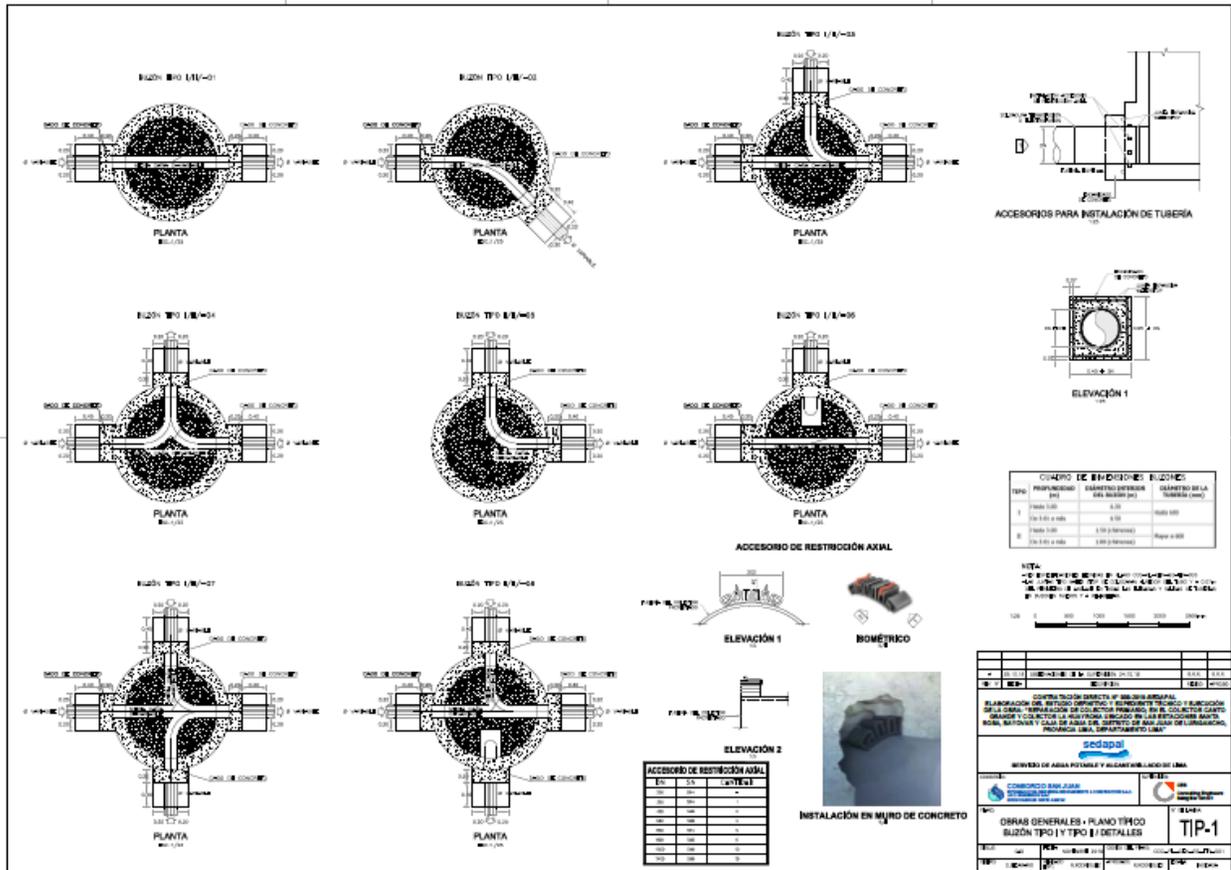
Plano Típico Buzones TIPO I Y TIPO II - Detalles
